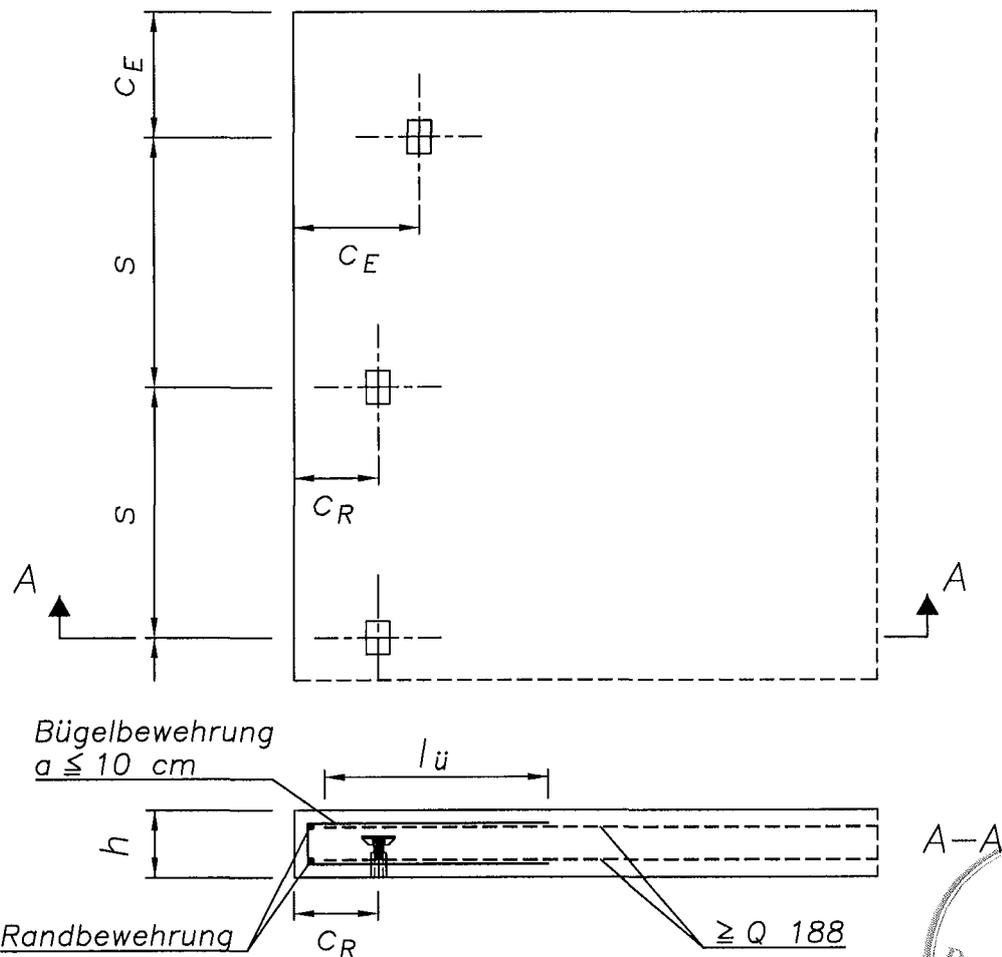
(Mindest-) Abstände, (Aufhänge-) Bewehrung
